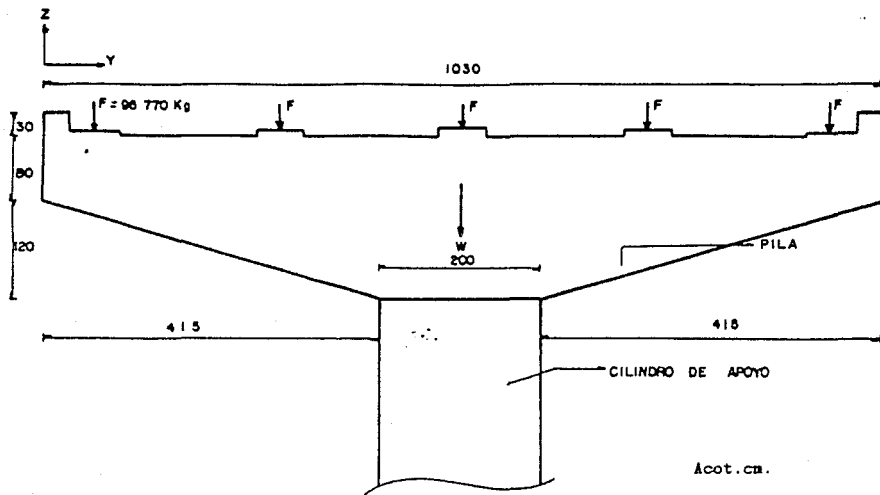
Pila número 3.- Dimensionamiento y sistema de cargas y de apoyo, donde la planta de la pila es la misma que la de la pila número 2
